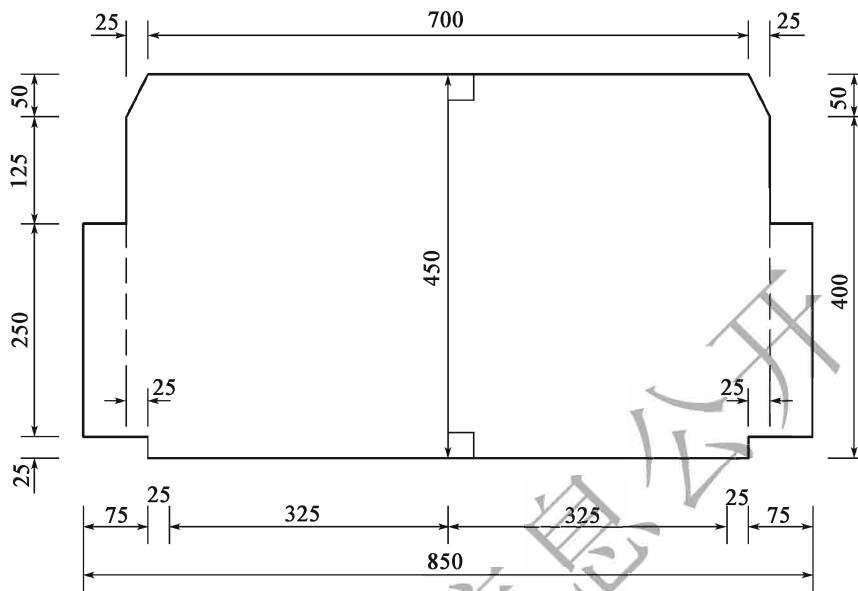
Dégagement de construction du tunnel routier de troisième classe à deux voies (30km/h) (unité :cm)
